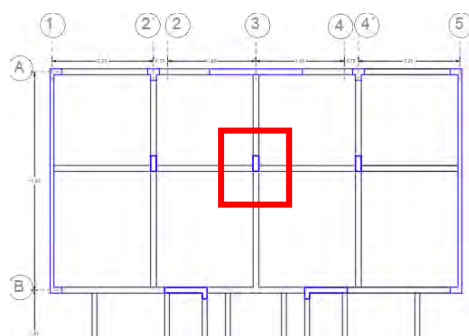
Vista en planta de las placas apoyadas en zapata Z-9
